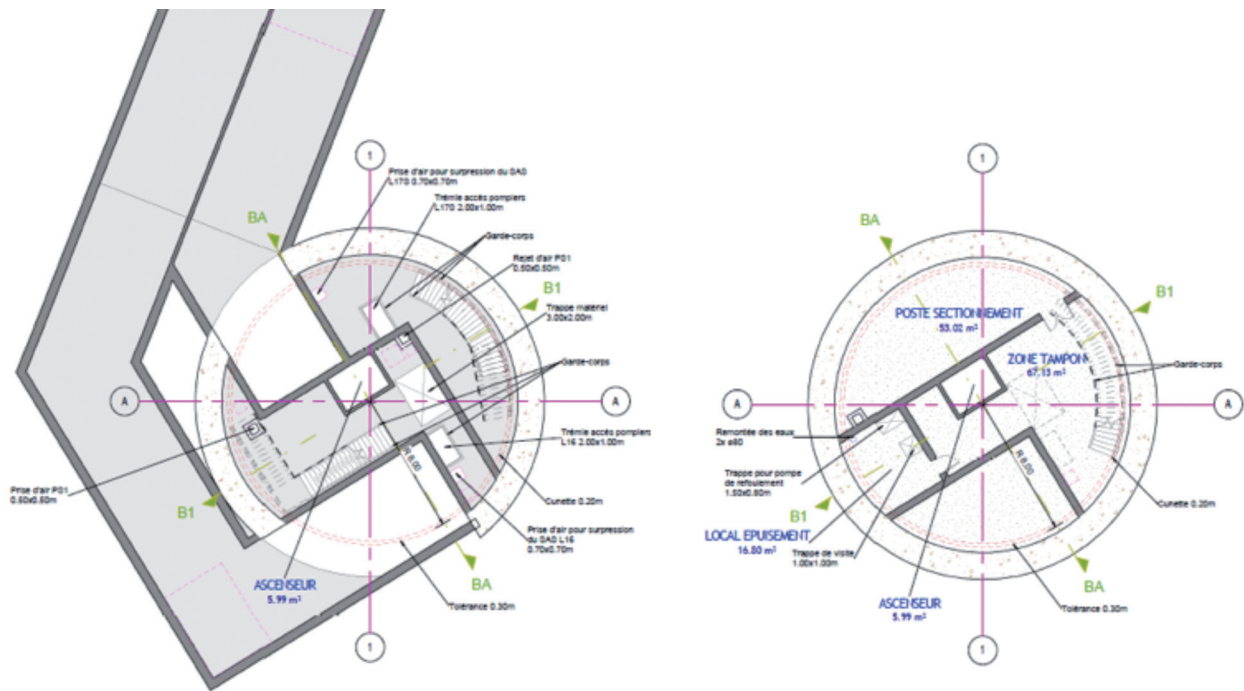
Vues en plan de plusieurs niveaux d'un puits type 1
